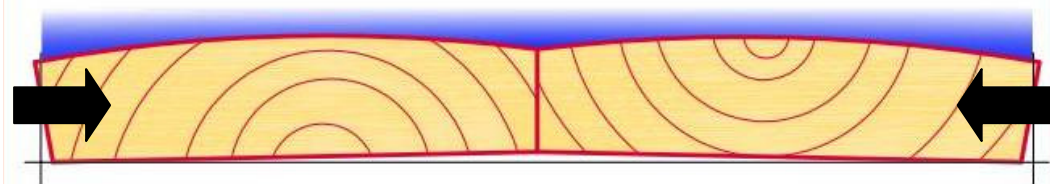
Effetto sulle liste di legno (correttamente posate) di un'eccessiva secchezza del massetto (ad es. accensione del riscaldamento a pavimento).
